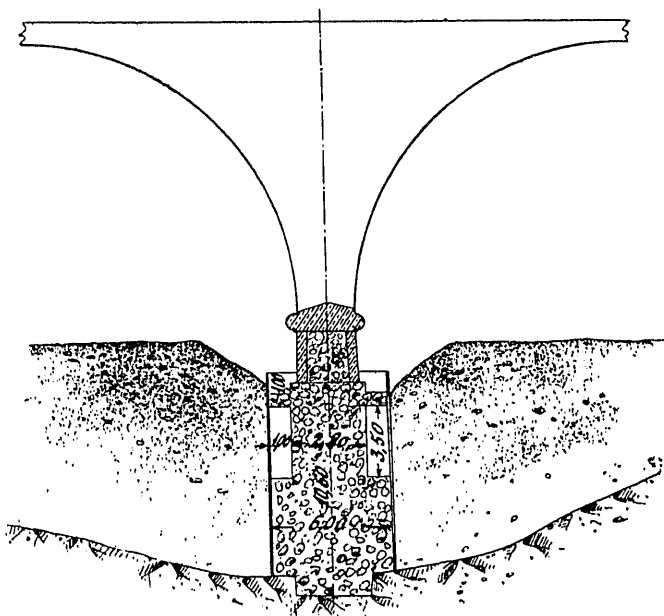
ª Disposición del recinto y corte de la 2.ª pila.
